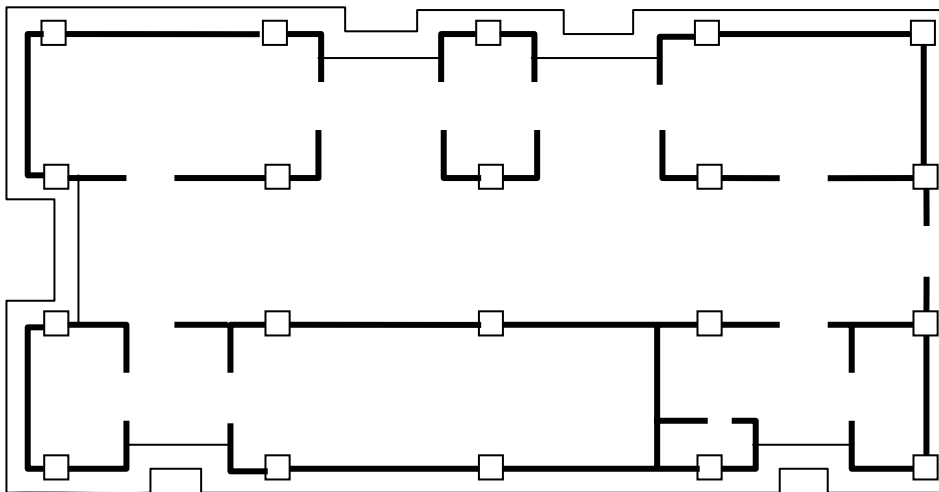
Planta arquitectónica del edificio de 7 niveles.
